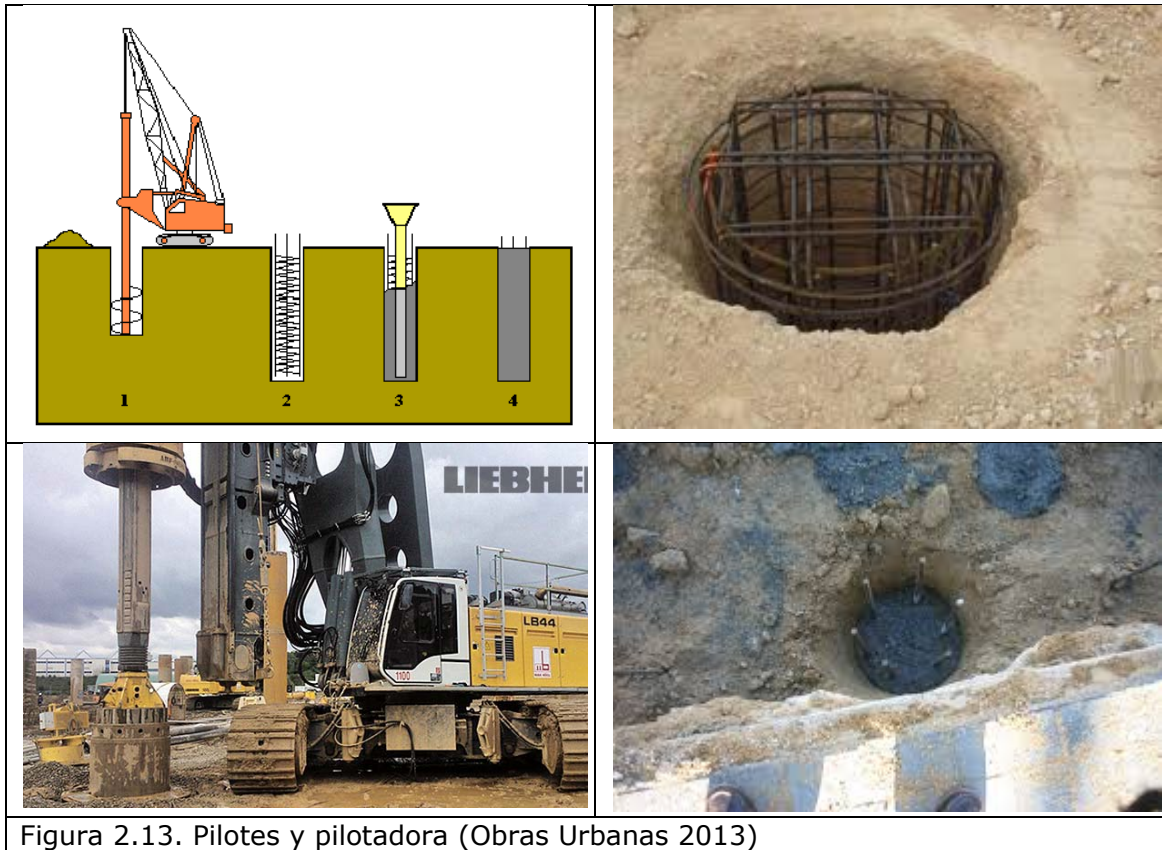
Pilotes y pilotadora (Obras Urbanas 2013)
